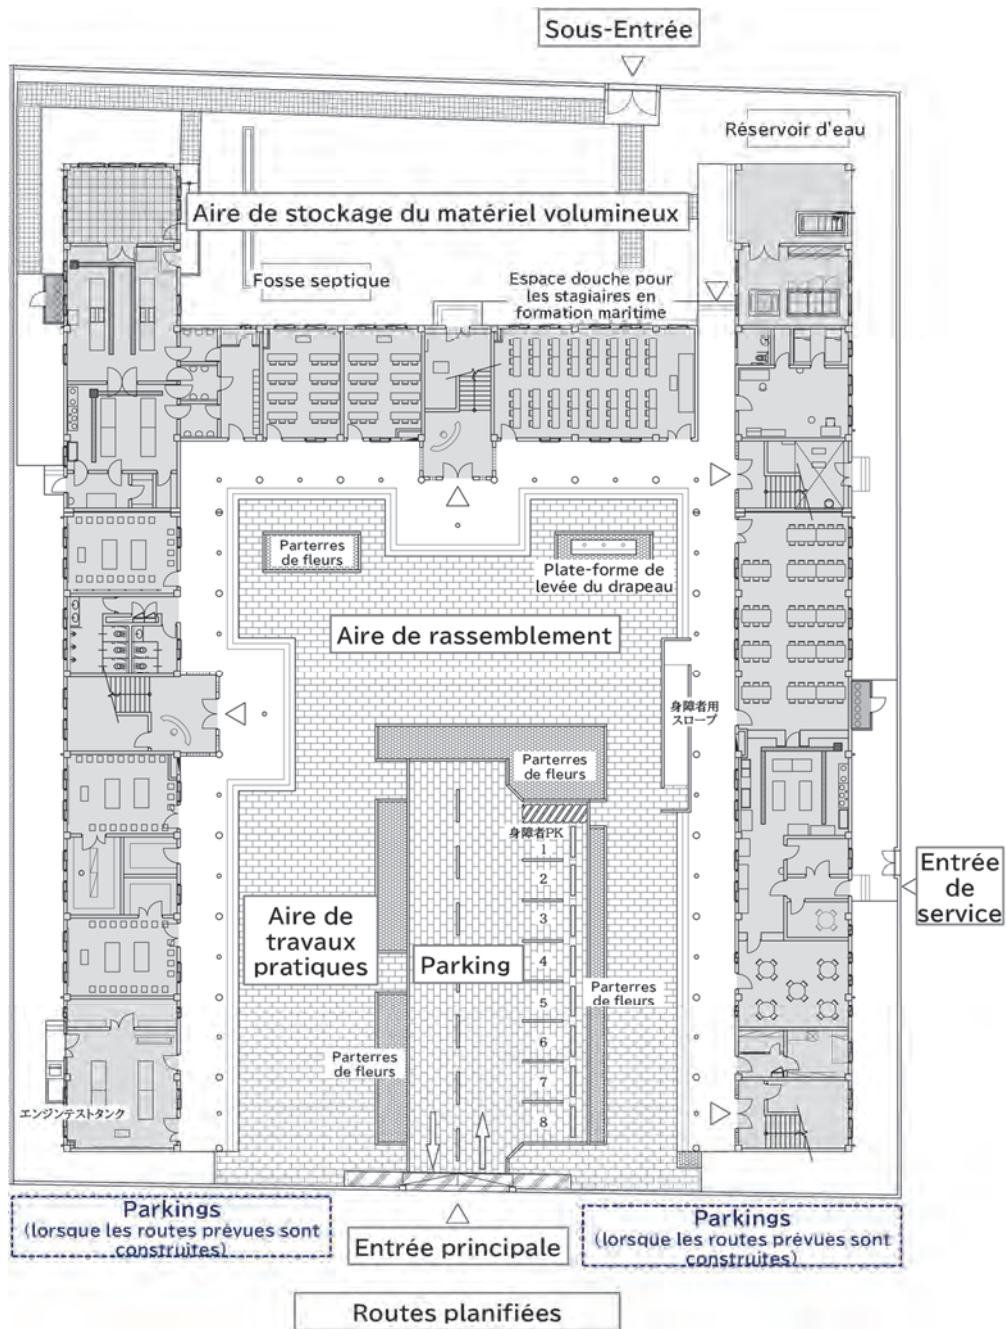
Plan d'implantation proposé pour les installations du CQFMP
